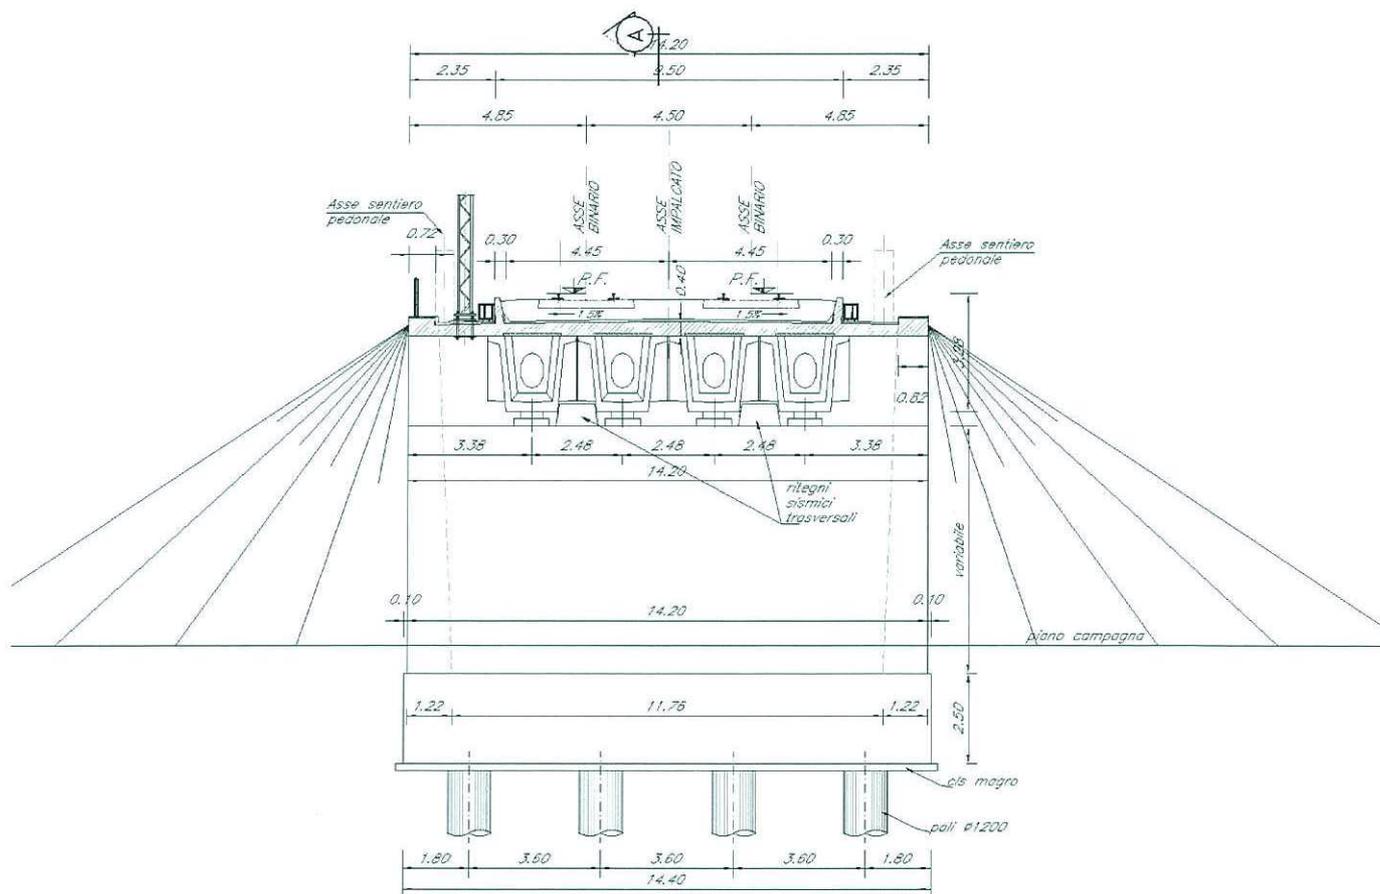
Sezione trasversale in asse appoggi della spalla tipo.
